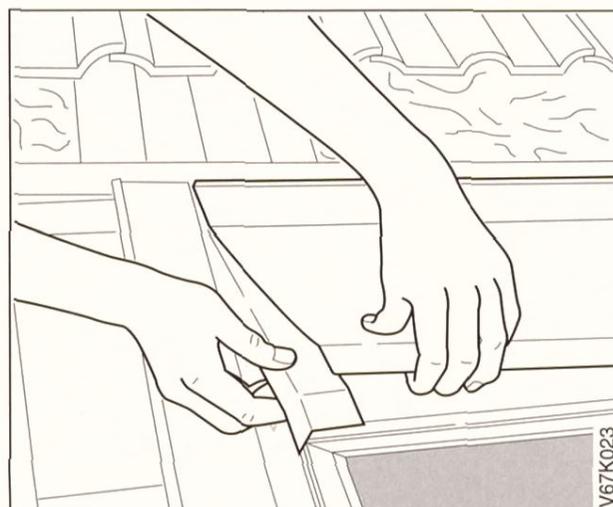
Eindeckecken oben links und rechts auflegen. Auf den oberen Flächen etwas Silikon auftragen. Obere Abschlußbleche auflegen und mit Blechnut in Kollektorfalz einschieben.
